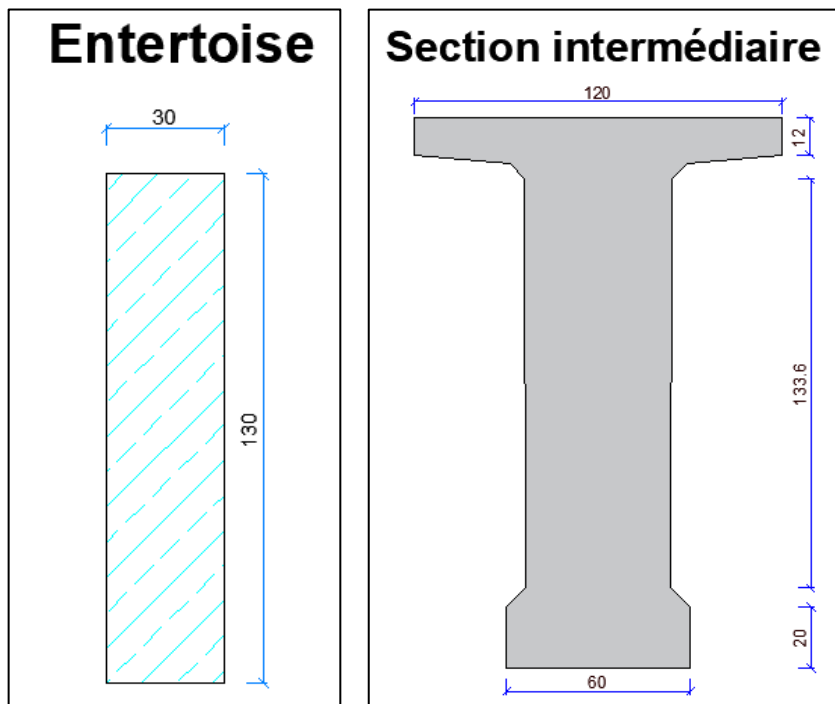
Les sections de la poutre VARIANTE 01
